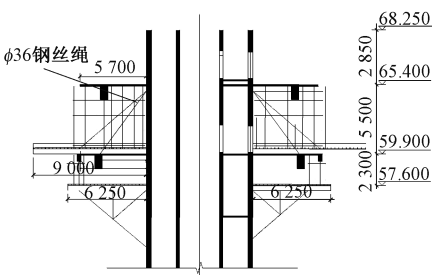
标高 65.400m 处悬挑结构第 1 次施工架体剖面
